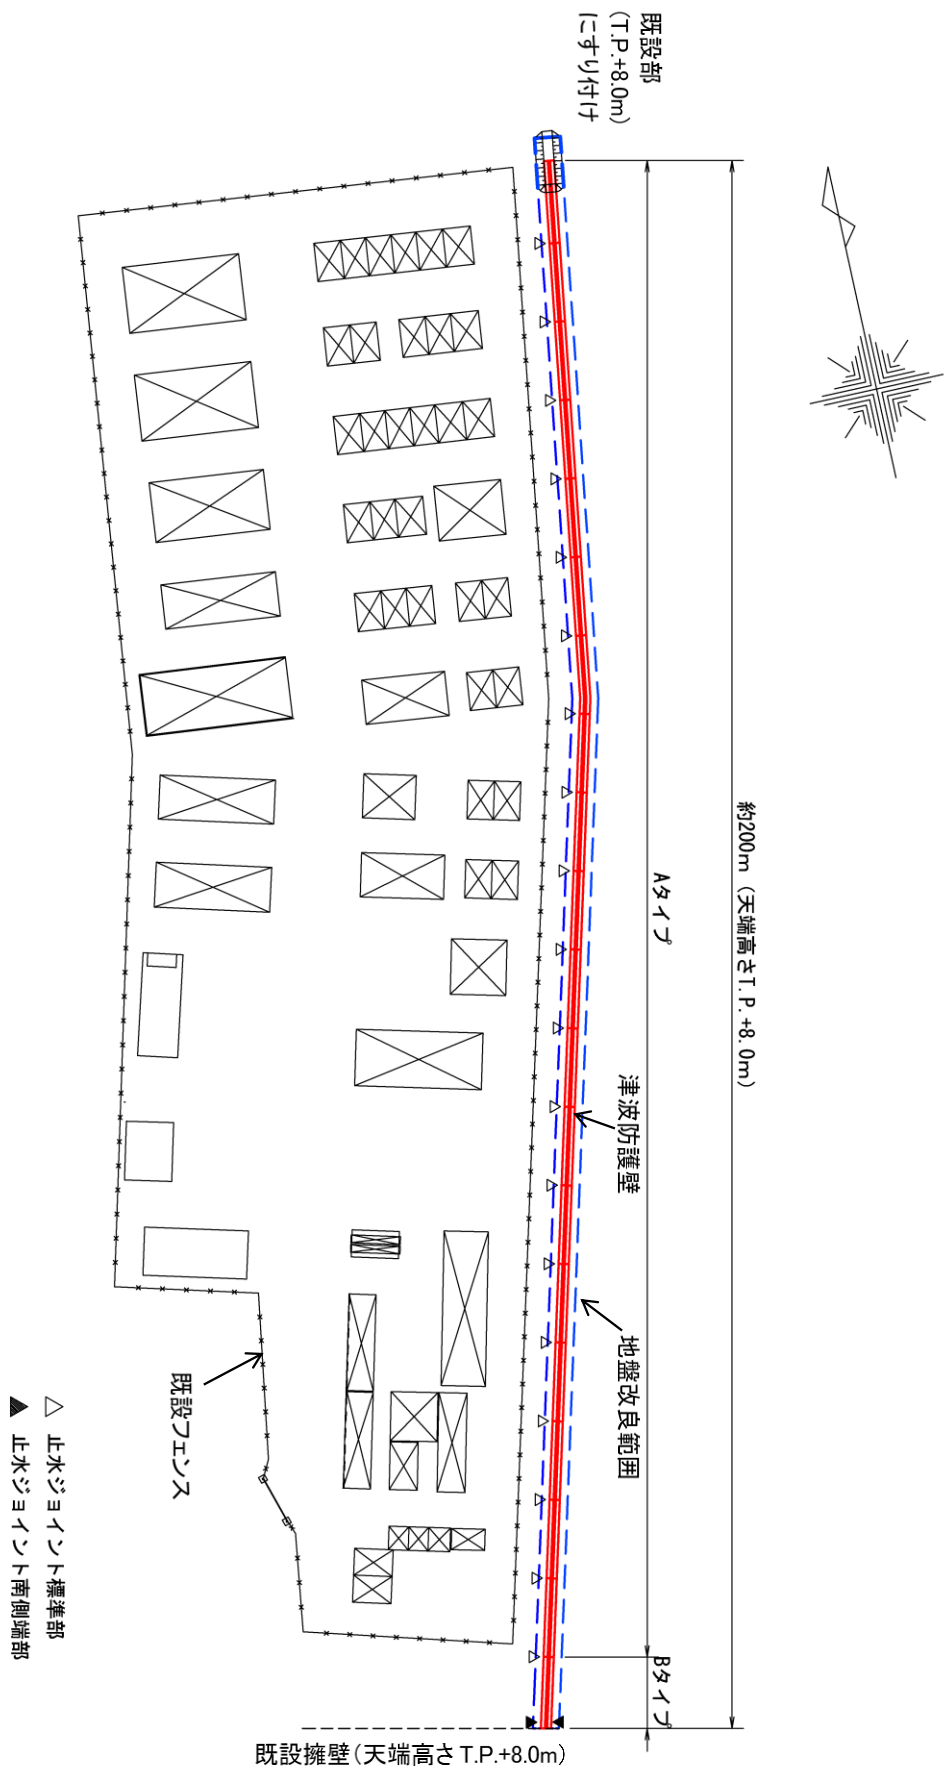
津波防護壁配置図 (保管廃棄施設・II)
